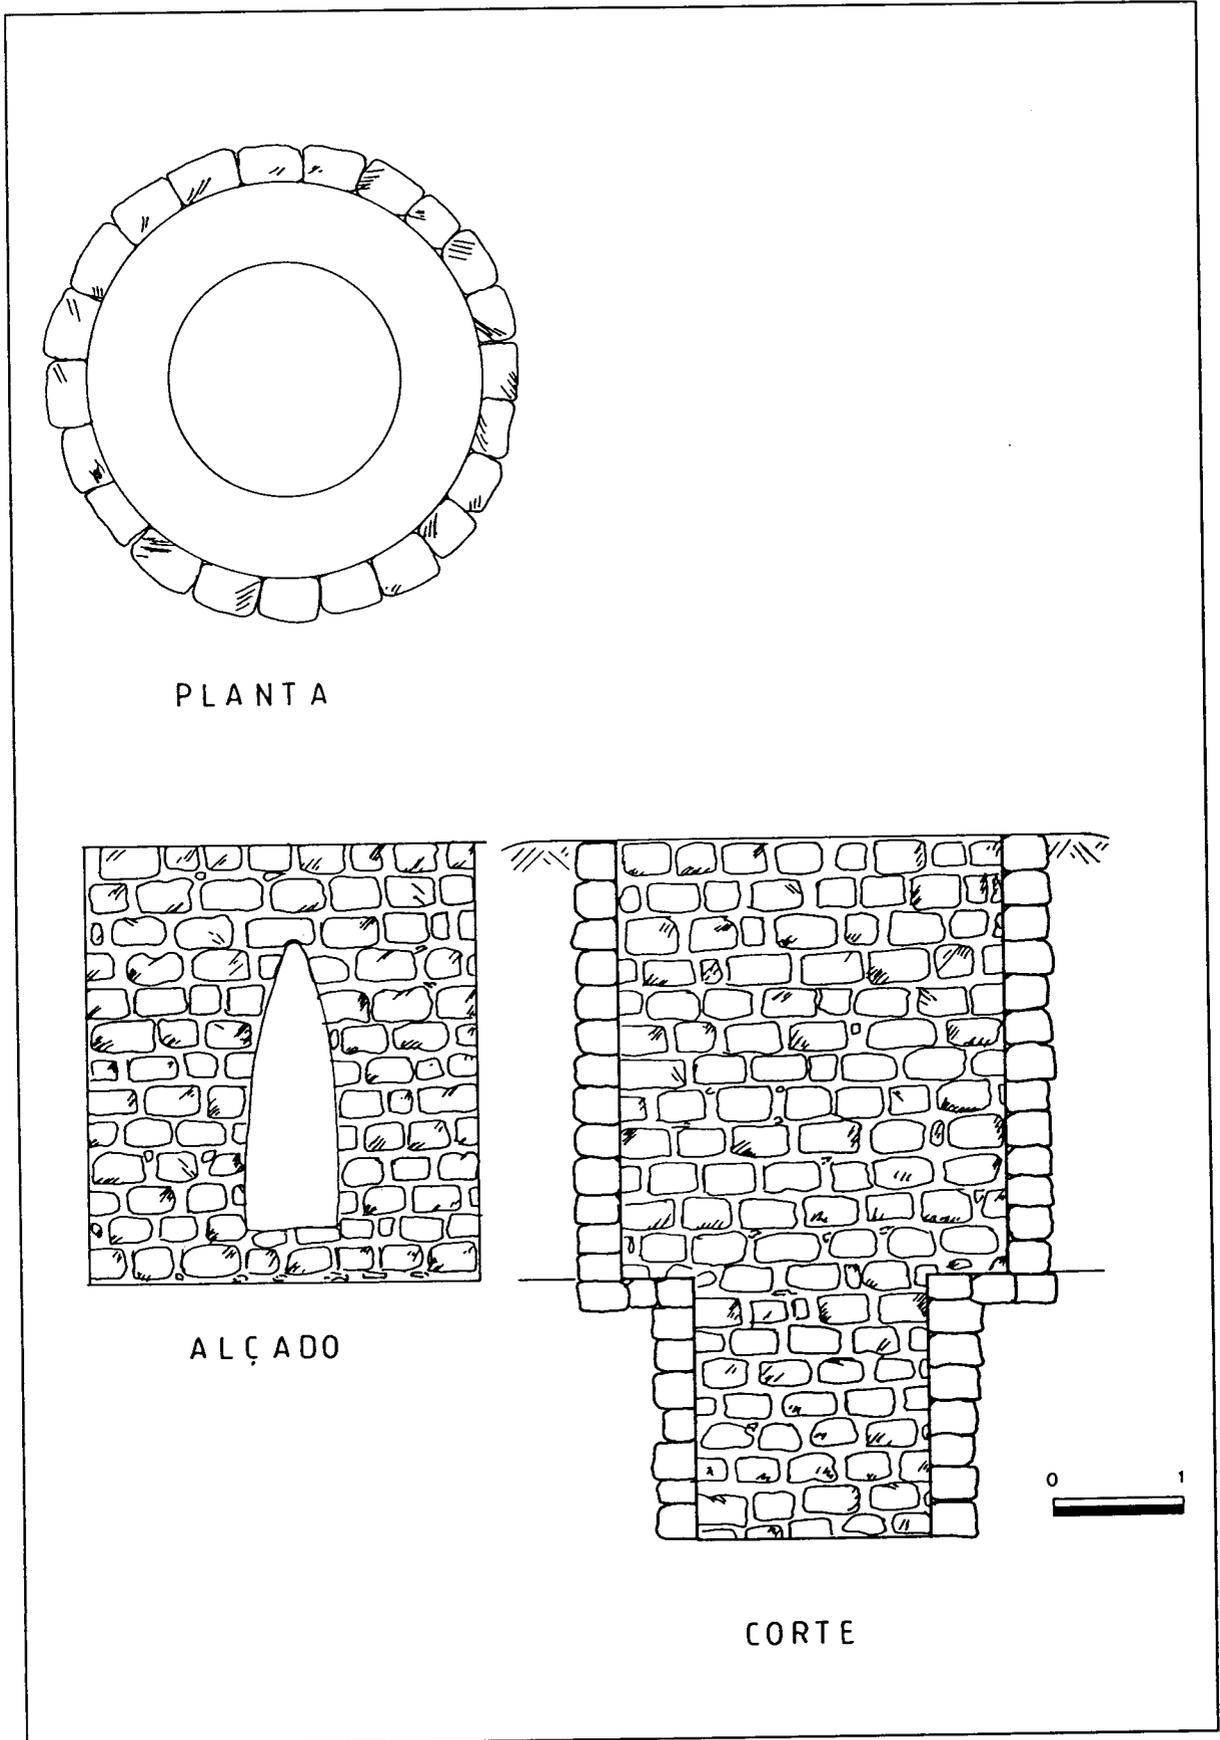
Forno vazio de Trigaches- planta, alçado e corte.
